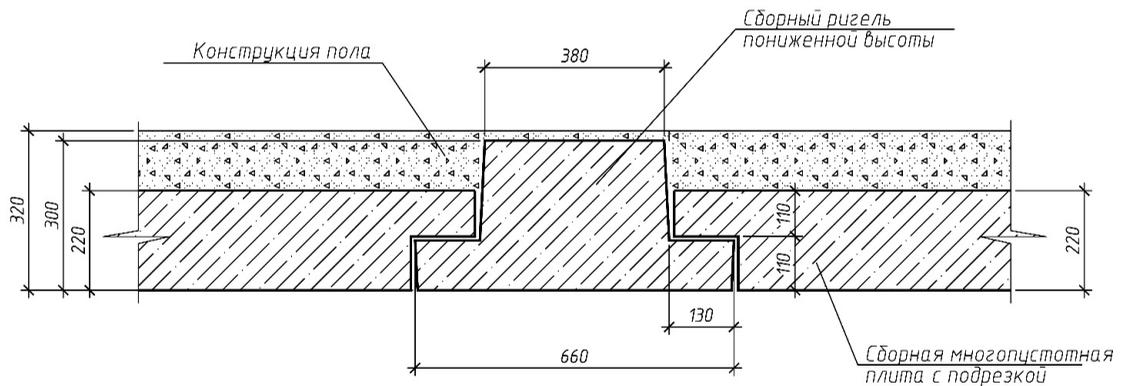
Узел сопряжения плит перекрытия с ригелем
